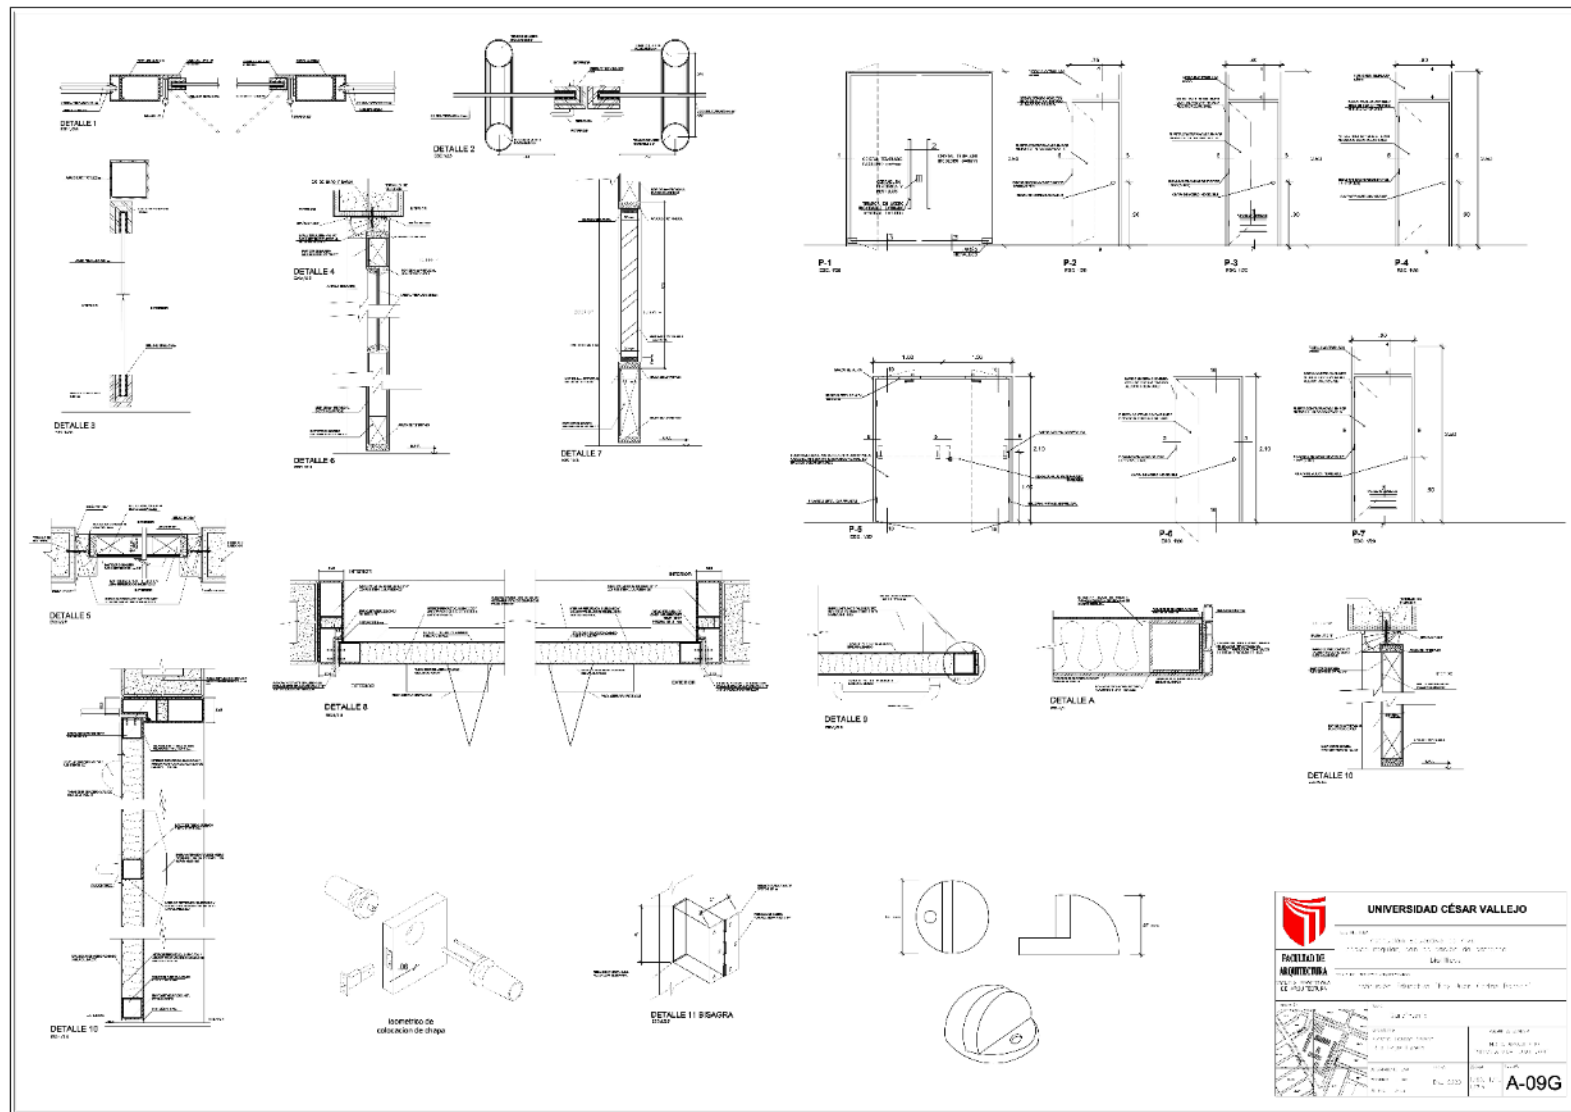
Plano Detalles de puertas y ventanas bloque "G", Fuente: elaboración propia
